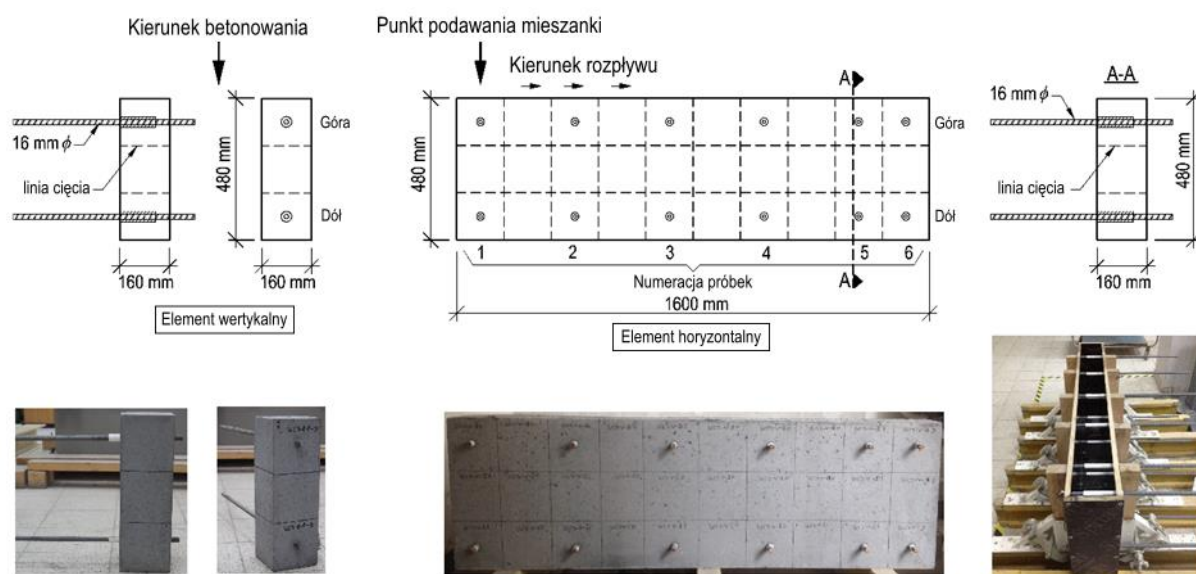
Widok elementów badawczych i sposobu ich betonowania [4.b.2]
